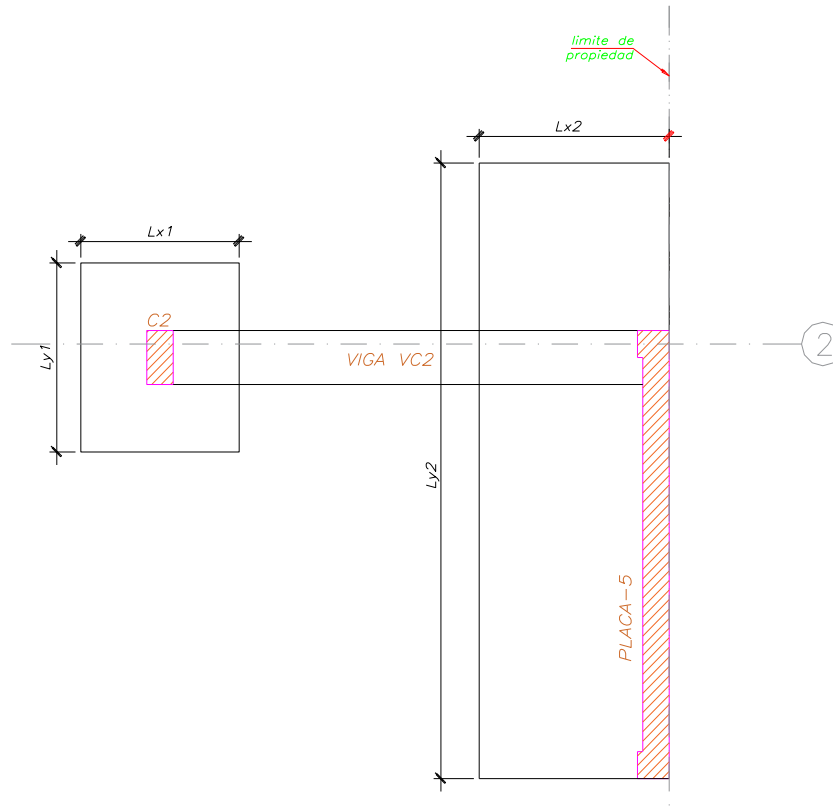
Zapatas Conectadas a Diseñar entre la Columna C5 y Placa PL-5
